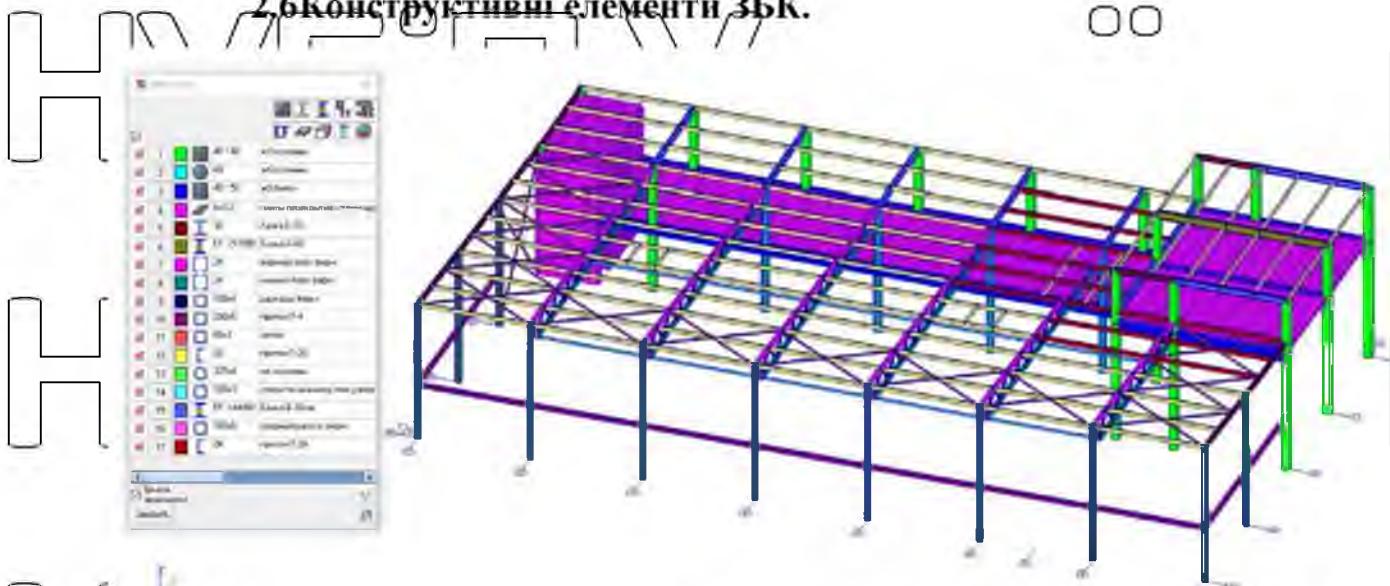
Загальний вигляд розрахункової схеми
